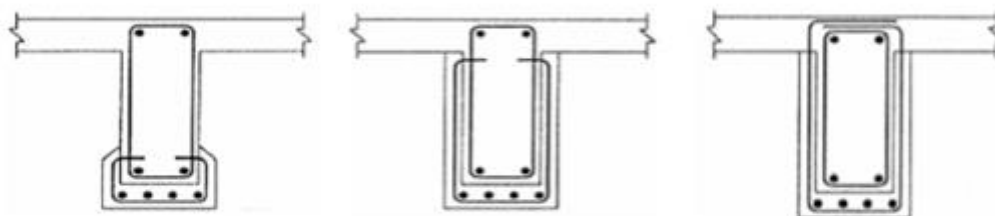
Disposição das armaduras mais utilizado no encamisamento de vigas. (Gomes, A., Appleton, J.).
